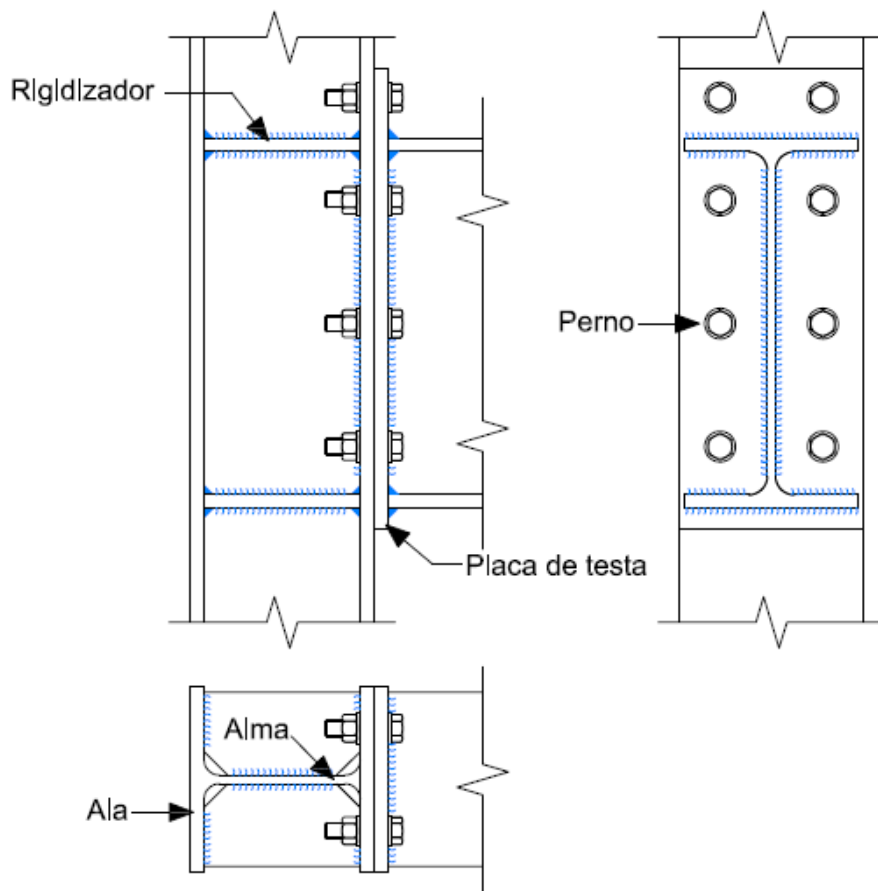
Detalle unión pilar-viga atornillada.
